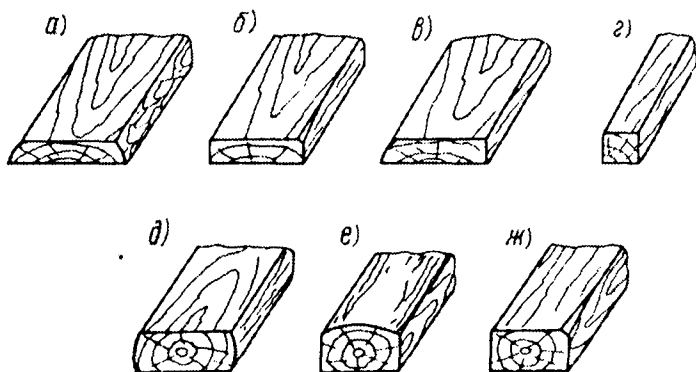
Виды пиломатериалов: а — необрезная доска; б — обрезная доска; в — односторонняя обрезная доска; г — брусок; д — брус двухкантный; е — брус трехкантный; ж — брус четырехкантный
